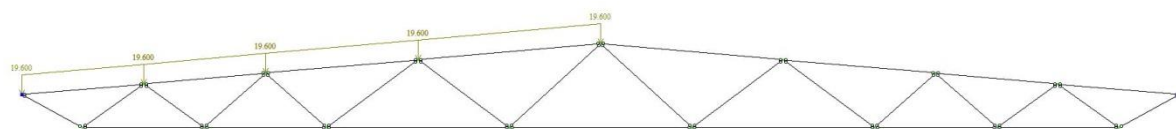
Расчетная схема фермы со снеговой нагрузкой на одном скате
